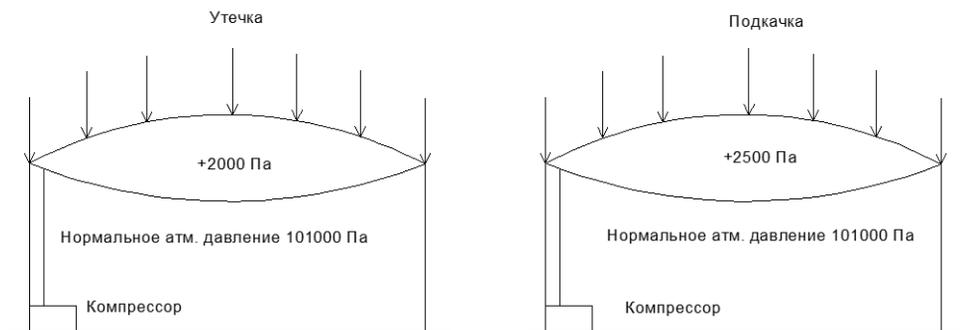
Подкачка и утечка воздуха в линзообразное пневматическое сооружение
